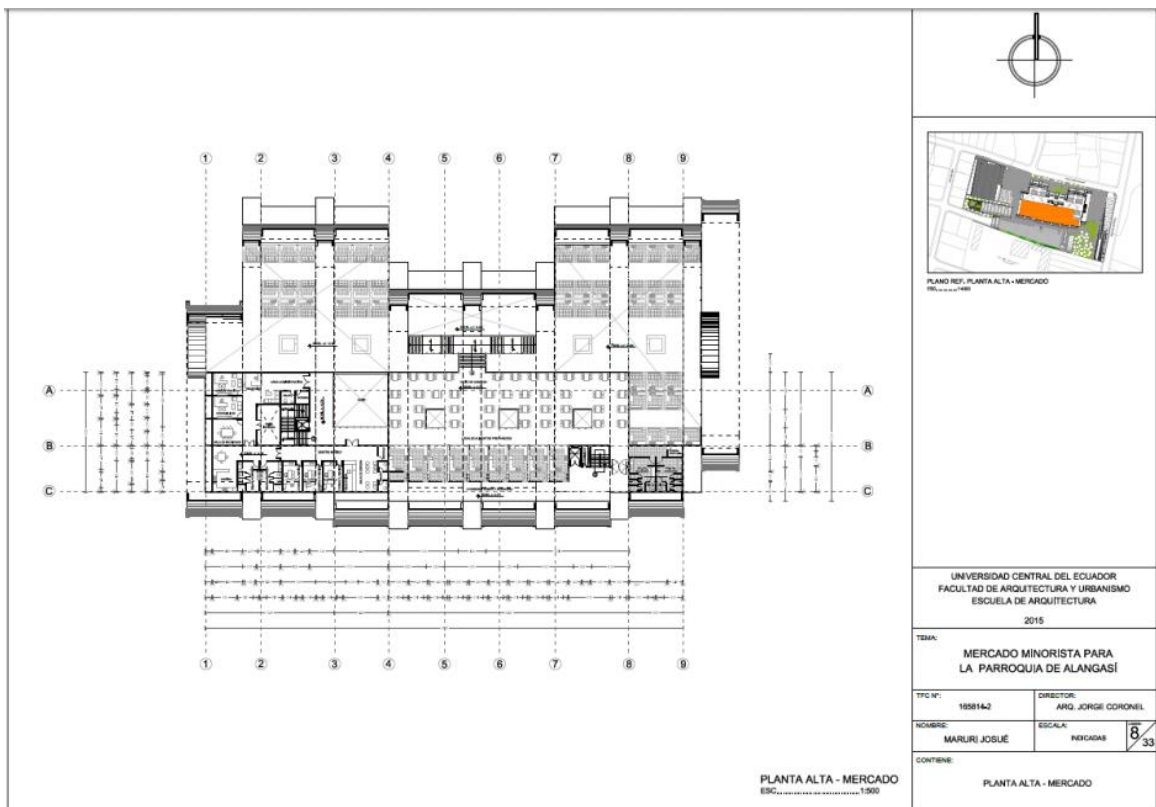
; PLANTA ALTA; Fuente: Josué Maruri Lovato
